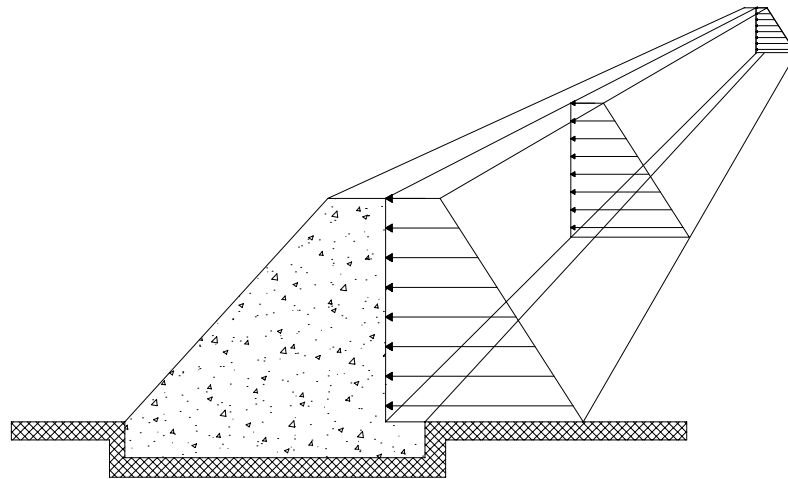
Problema do Estado plano de deformações (EPD).
